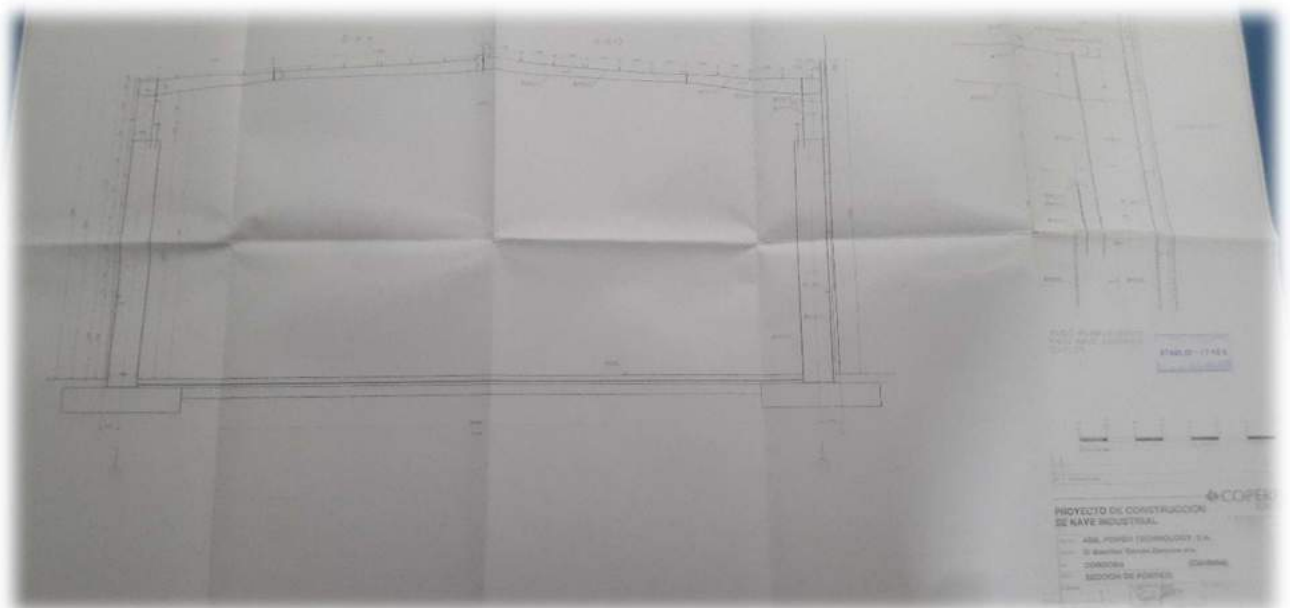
Plano alzado nave de Expediciones.
